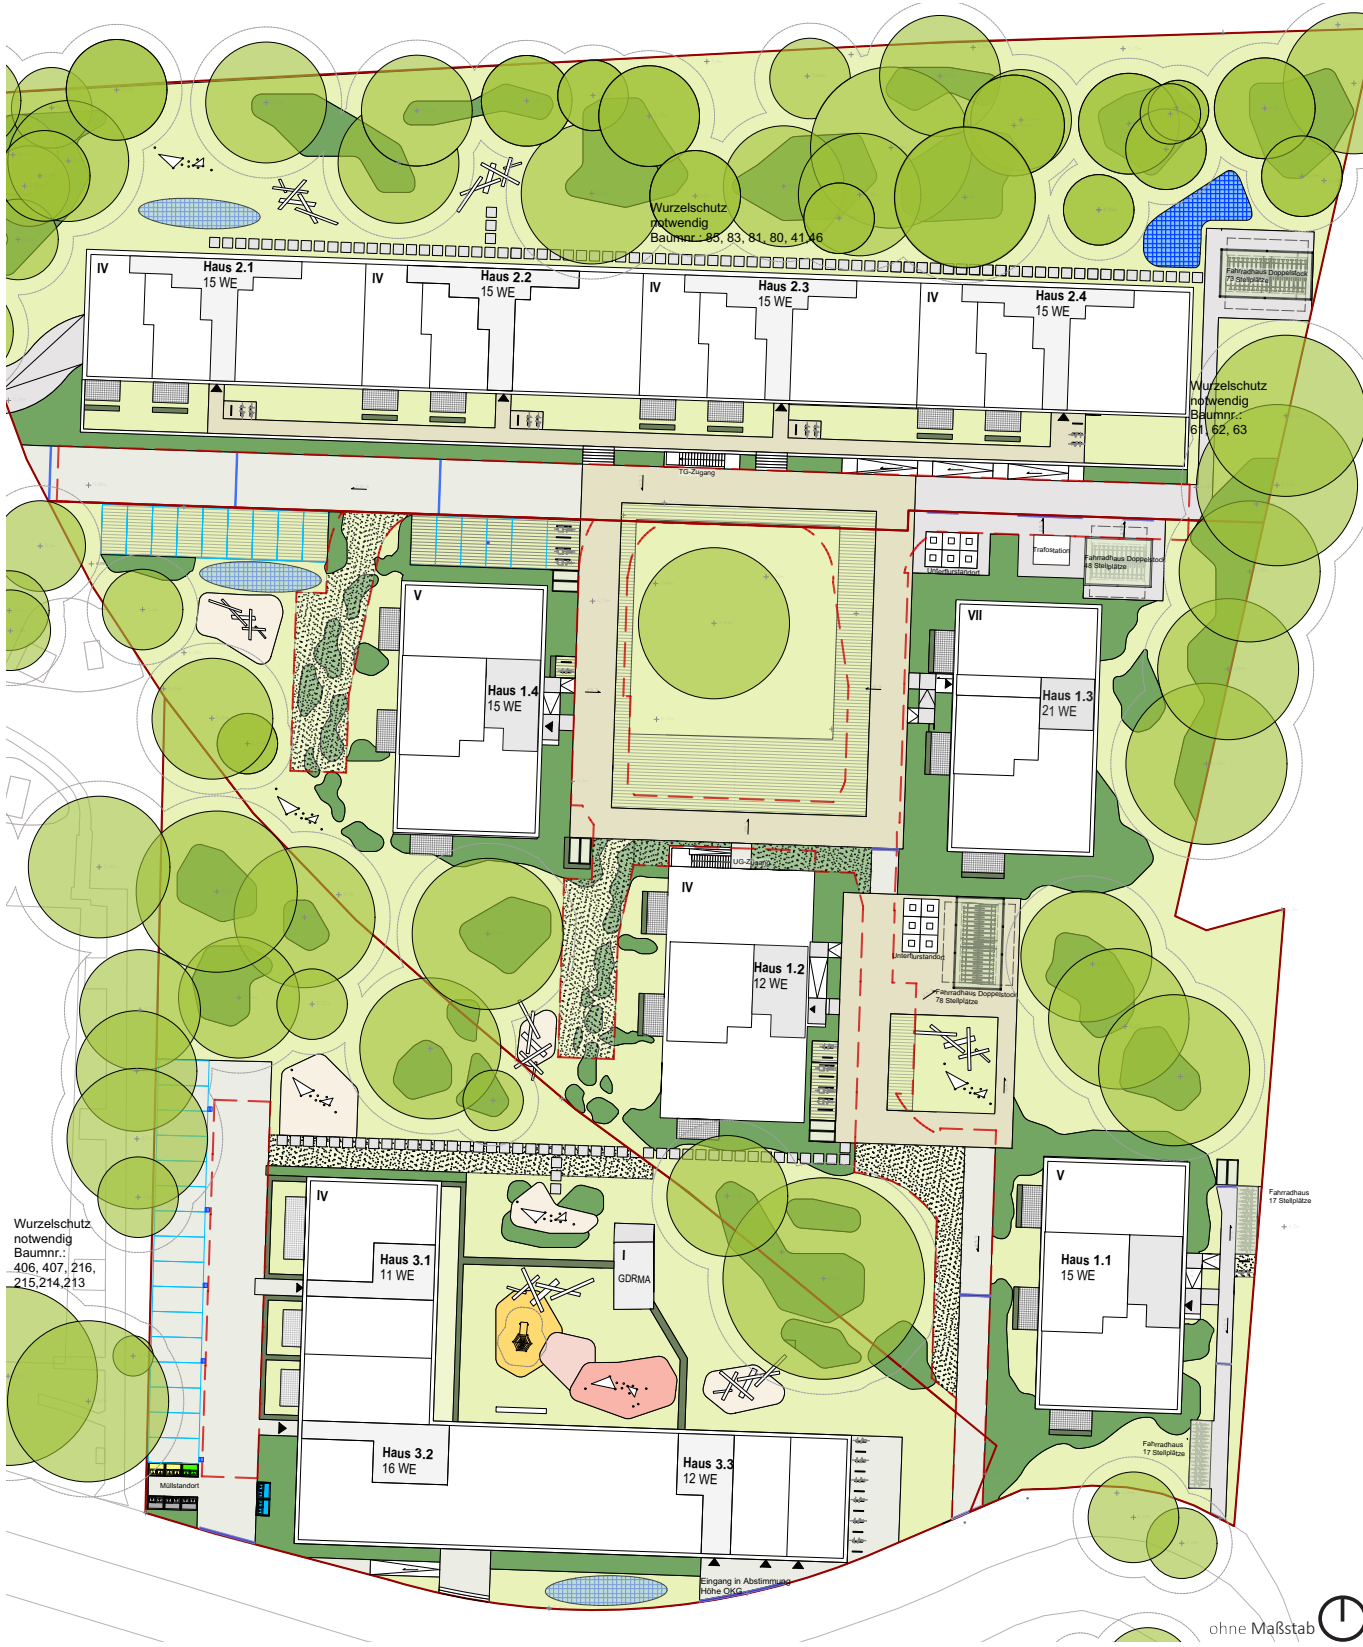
Ausschnitt Lageplan mit geplanter Bebauung (Lichtenstein Landschaftsarchitektur
